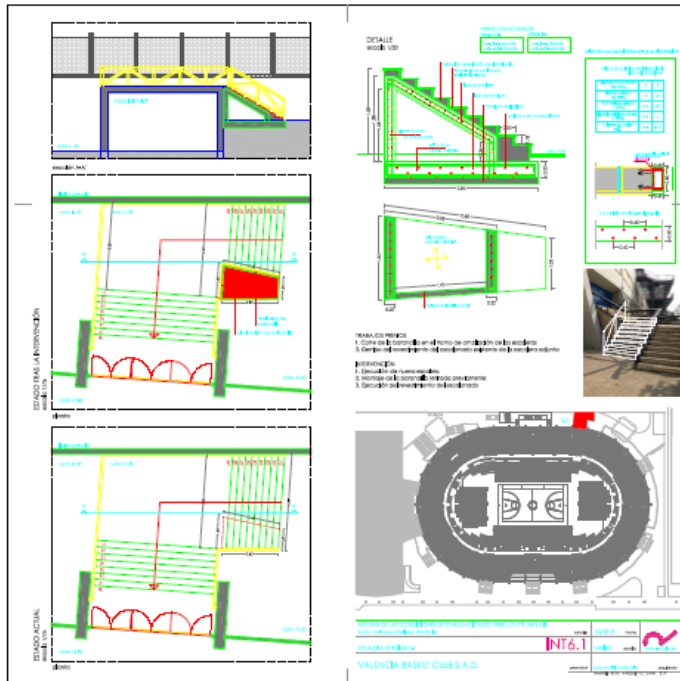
Plano de Ampliación de Escalera E-E. Plano 20.
